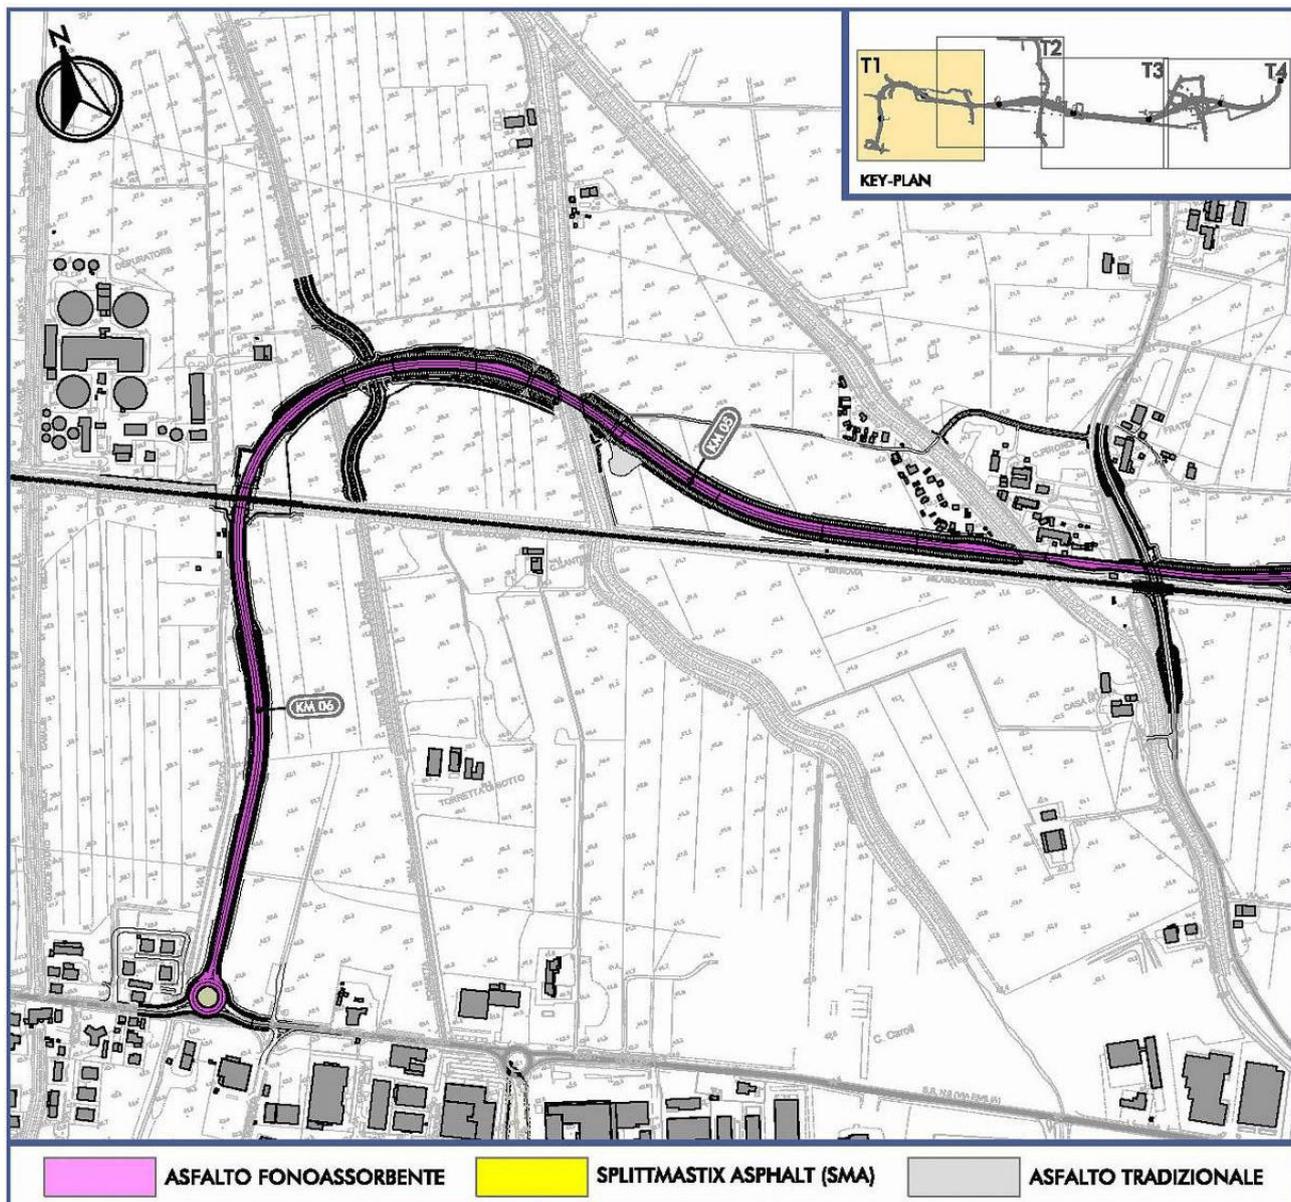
Pavimentazioni stradali di progetto nel tratto tra la pk 4+500 e il fine intervento a Corte Tegge
